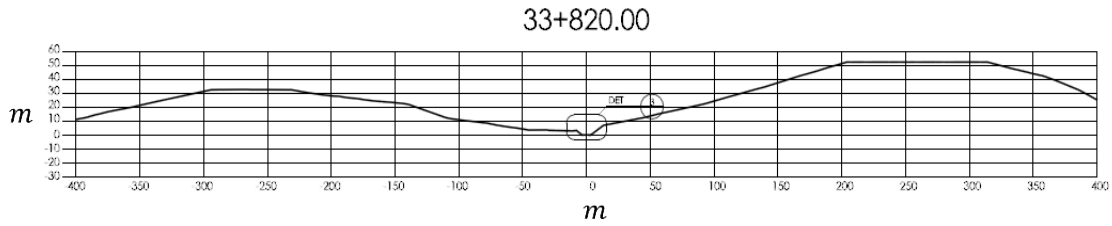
Seção transversal tipo corte-corte – seção completa (estaca 33+820.00 m)
